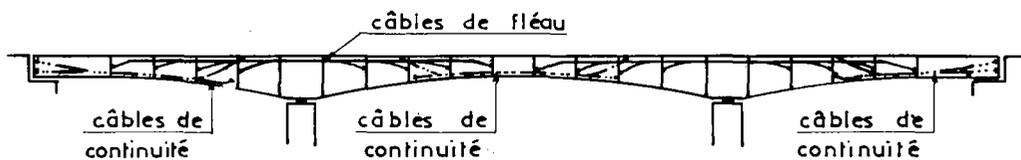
Schéma de câblage d'un ouvrage à trois travées.
